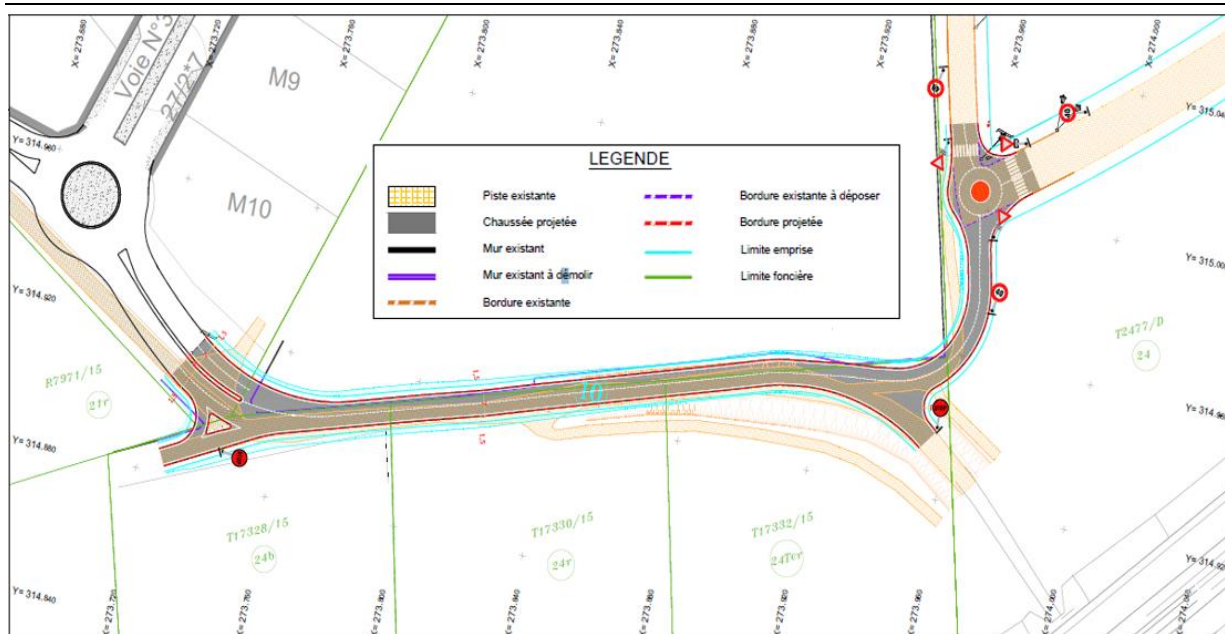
Tracé en plan de la voie d'accès N°2 et carrefour – Extension de la ZI Had Soualem.
